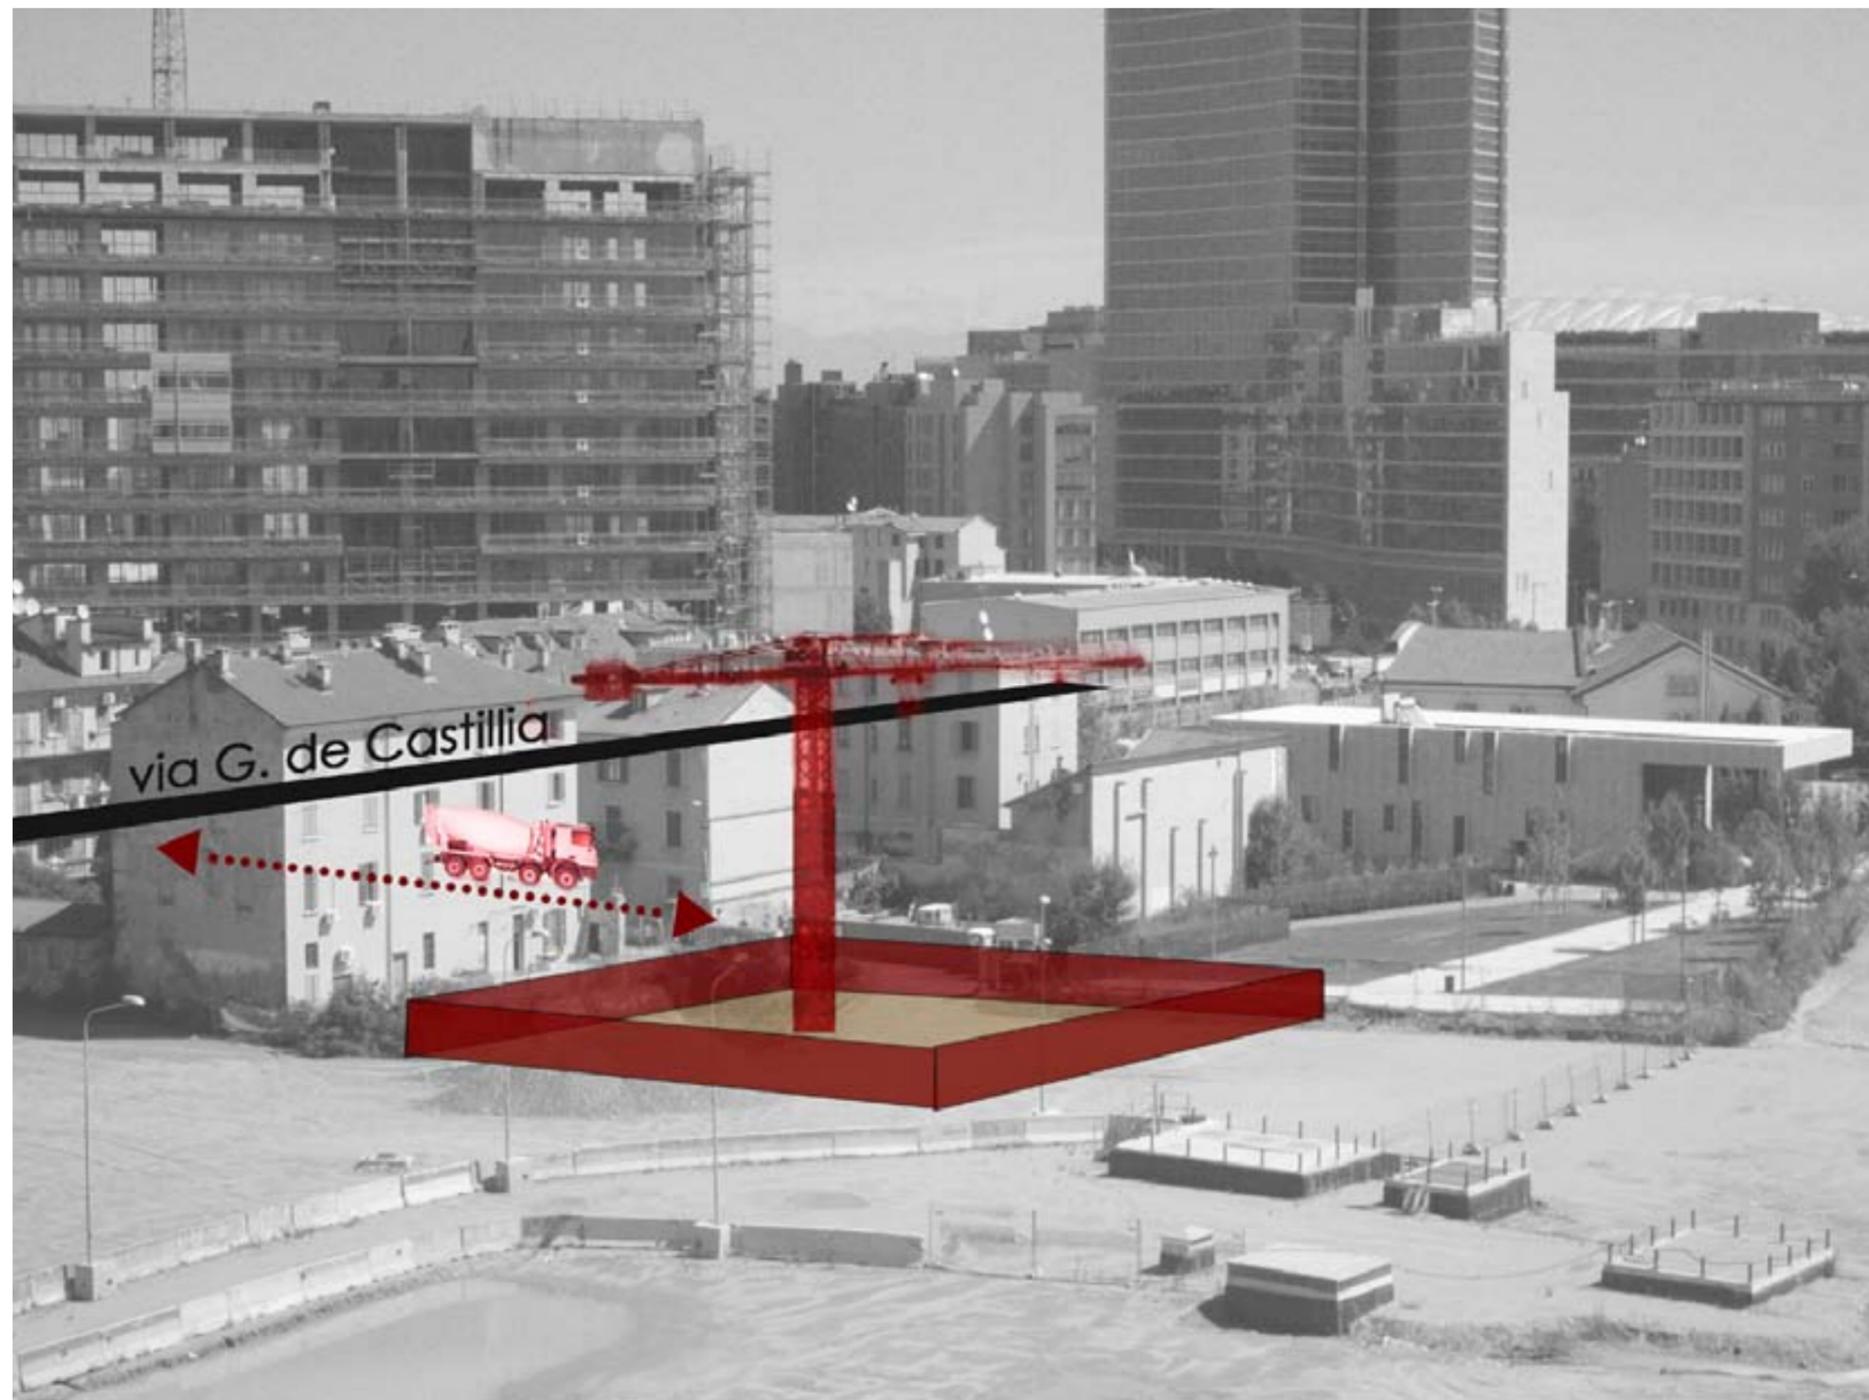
| Individuazione dell'area di cantiere e dei suoi accessi.
